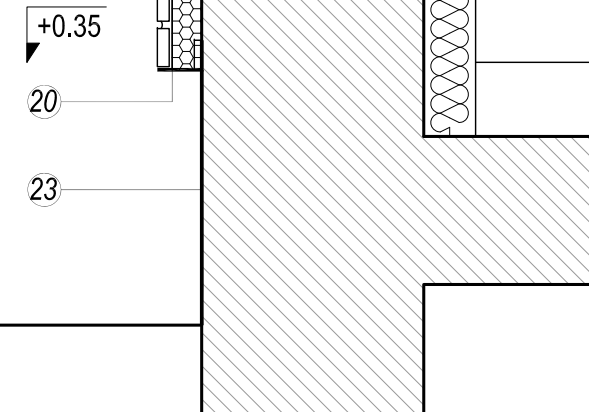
DETAIL HABILLAGE DE LA FACADE EN BRIQUE
